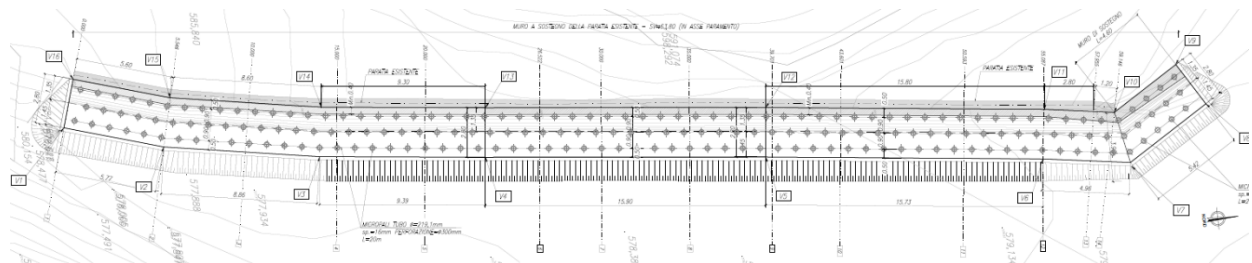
Stralcio planimetrico muro di consolidamento della berlinese esistente.
